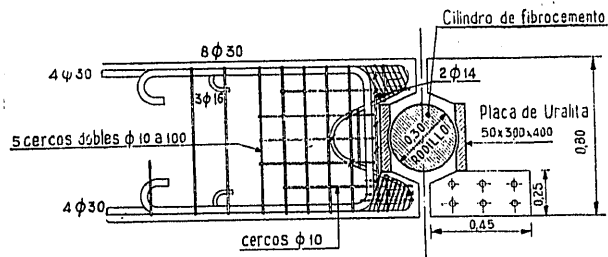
ª — Detalle de la articulación en clave (arco de 40 m.).
